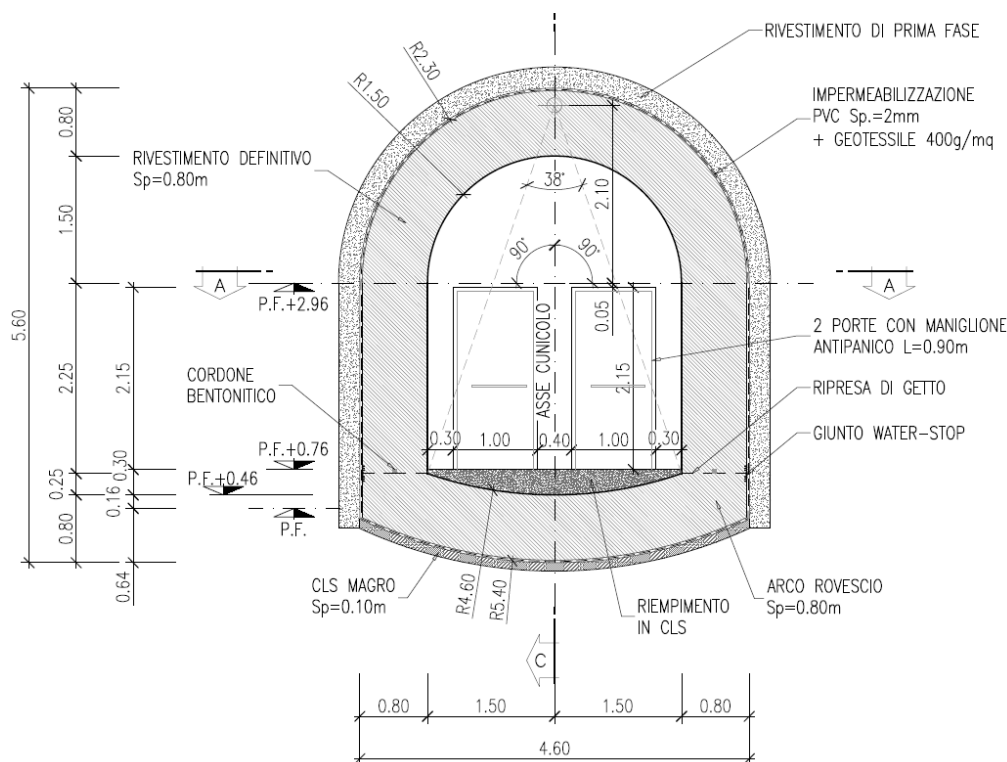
Sezione trasversale del cunicolo di collegamento.
